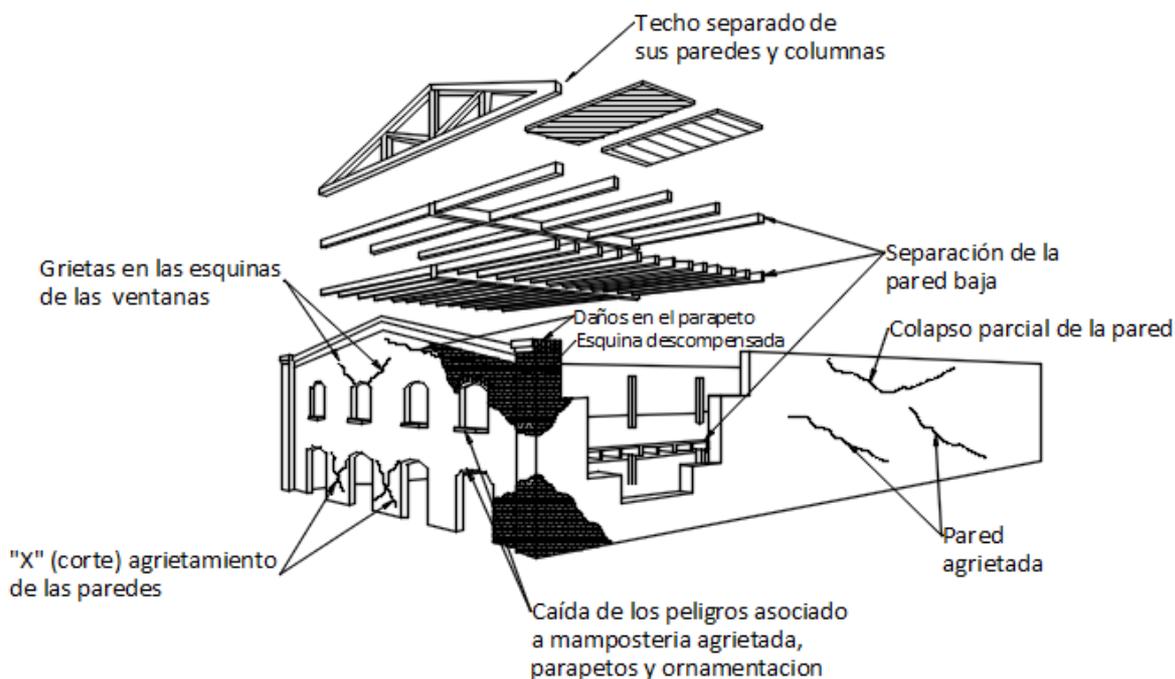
Puntos de inspección para edificaciones pequeñas construidas con paredes de mampostería sin refuerzo estructural.
